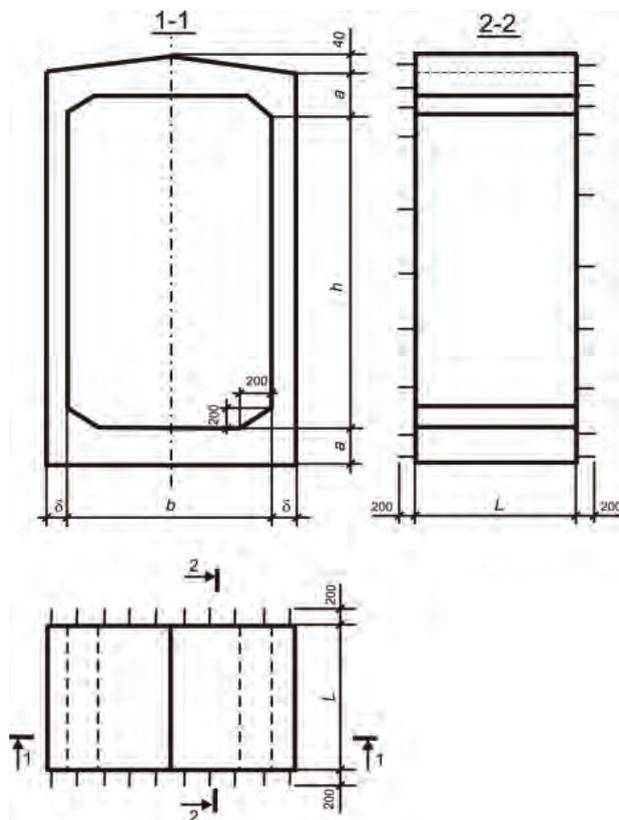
Схема унифицированного железобетонного блока ЗТП
